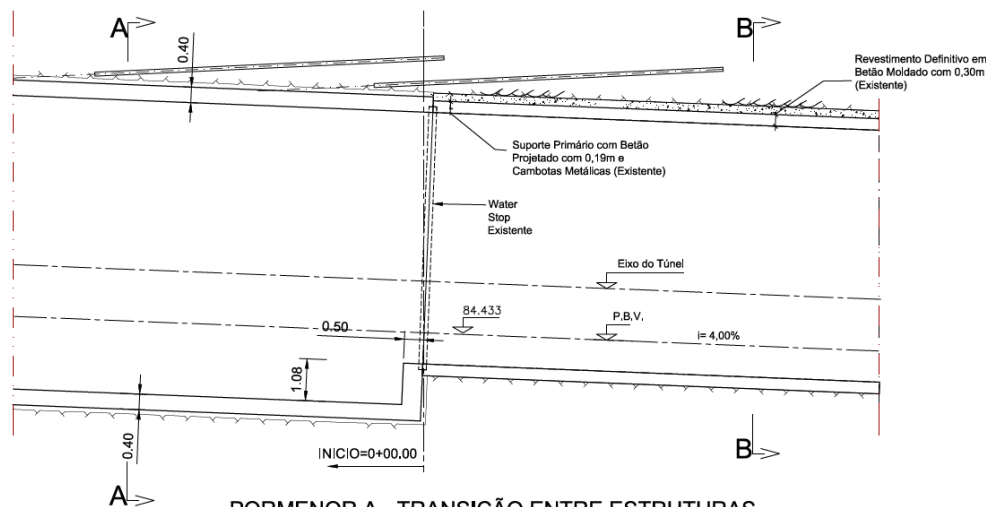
Estruturas a construir na OE1 e estruturas existentes conforme anexo N das cláusulas técnicas do caderno de encargos.
